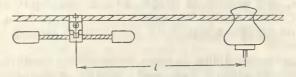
Двойное усиленное угловое крепление провода на штыревых изоляторах на штырях угловой опоры.
